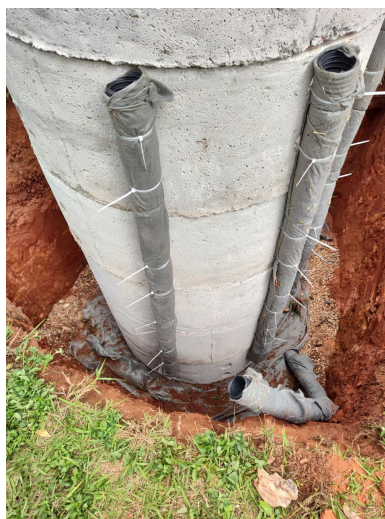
Poço de infiltração - detalhe dos dispositivos de infiltração.
